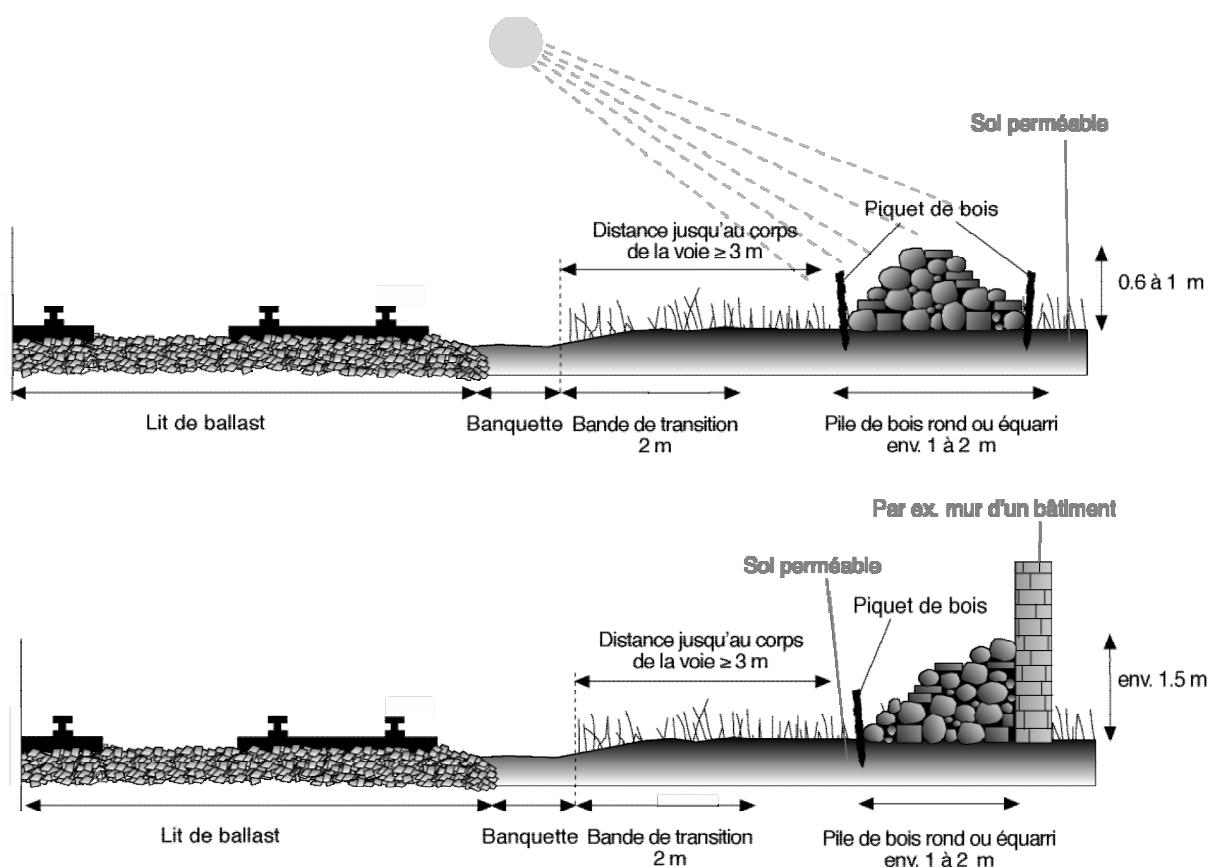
coupe transversale d'une pile de bois. En haut : sur terrain plat ; en bas contre un mur.
